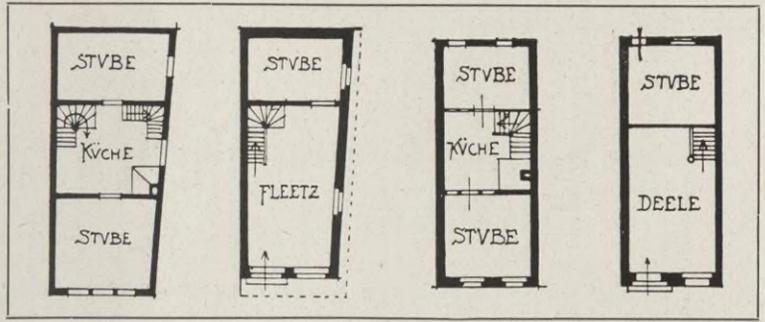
Grundrisse von Handwerkerhäusern in Lübeck und Kolmar¹⁾
